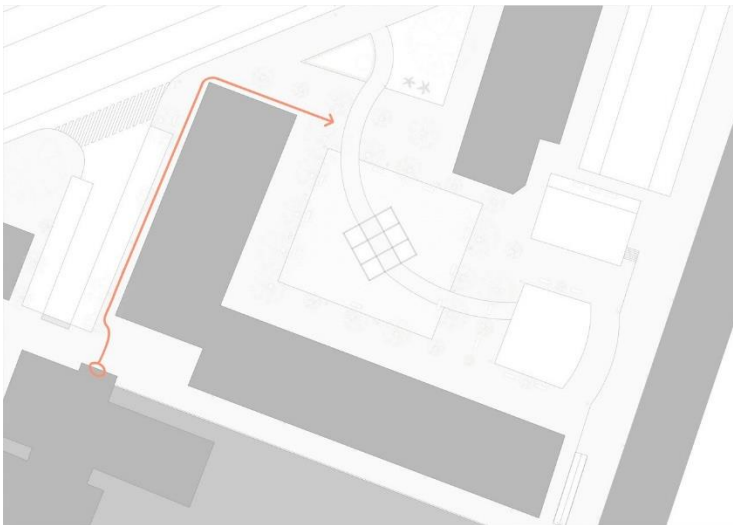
Recorrido 1 puerta calle Séneca.
